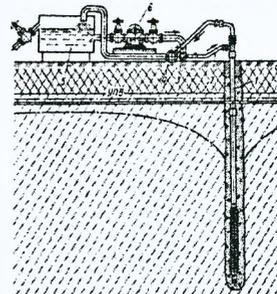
Схема двухъярусного водопонижения иглофильтрами
